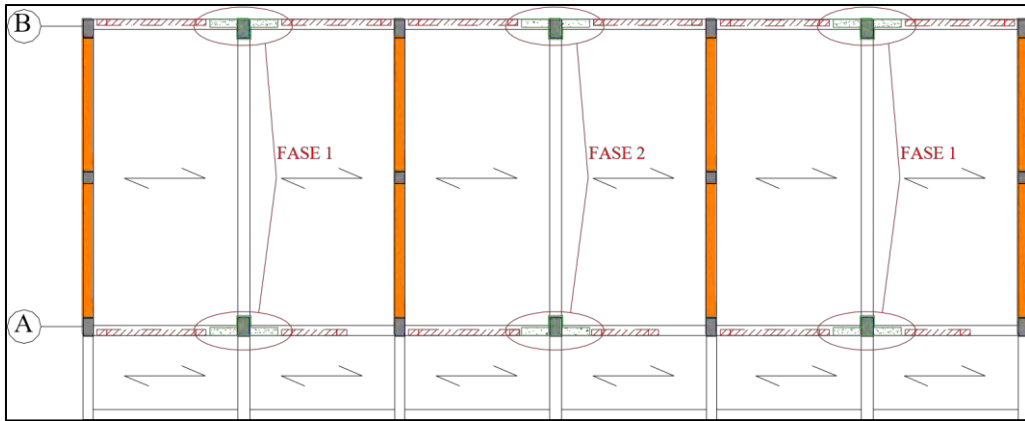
Planta de refuerzo de murete de albañilería reforzado con malla (Fuente: Loa, 2017)
